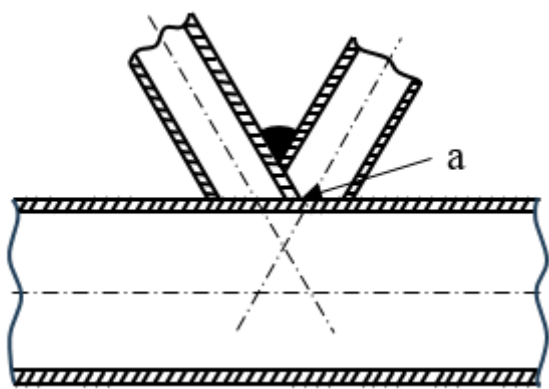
空心管斜焊缝的形式与尺寸
